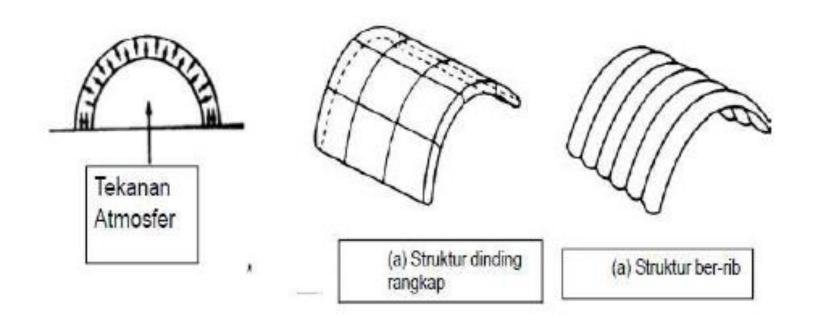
Struktur yang ditumpu udara (air supported structure)
